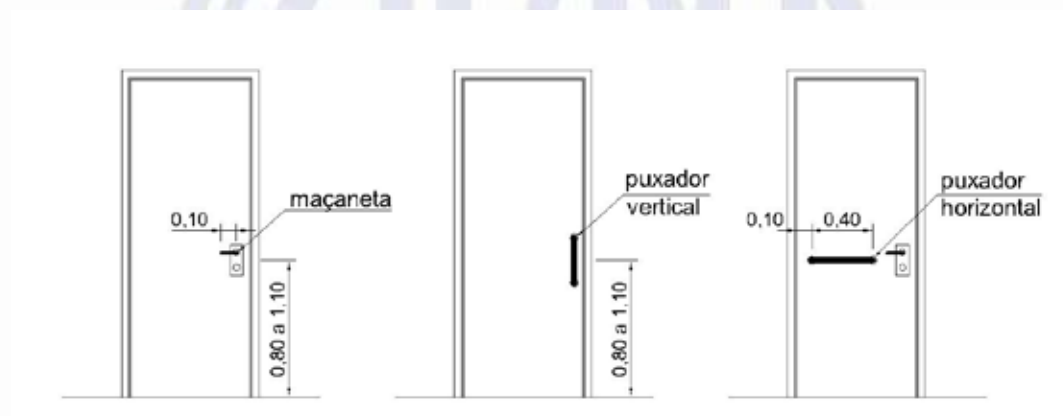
Localização de maçanetas e puxadores – Exemplos
